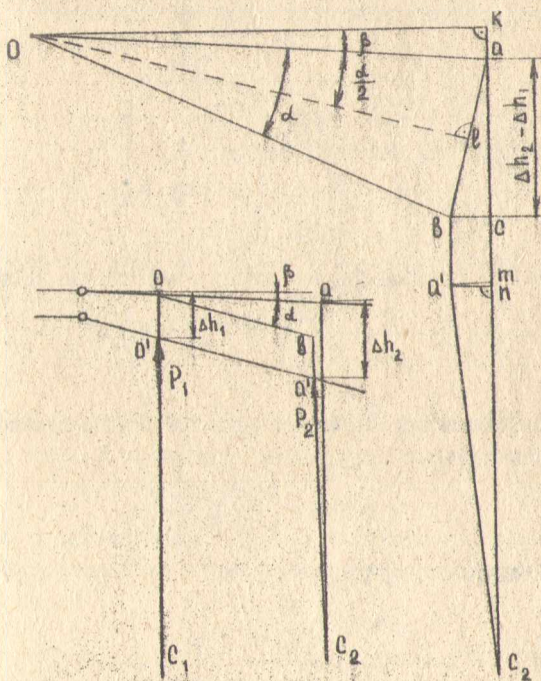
Рис. I. Расчетная схема определения относительных углов поворота перекрытия крыши \mathcal{L}
